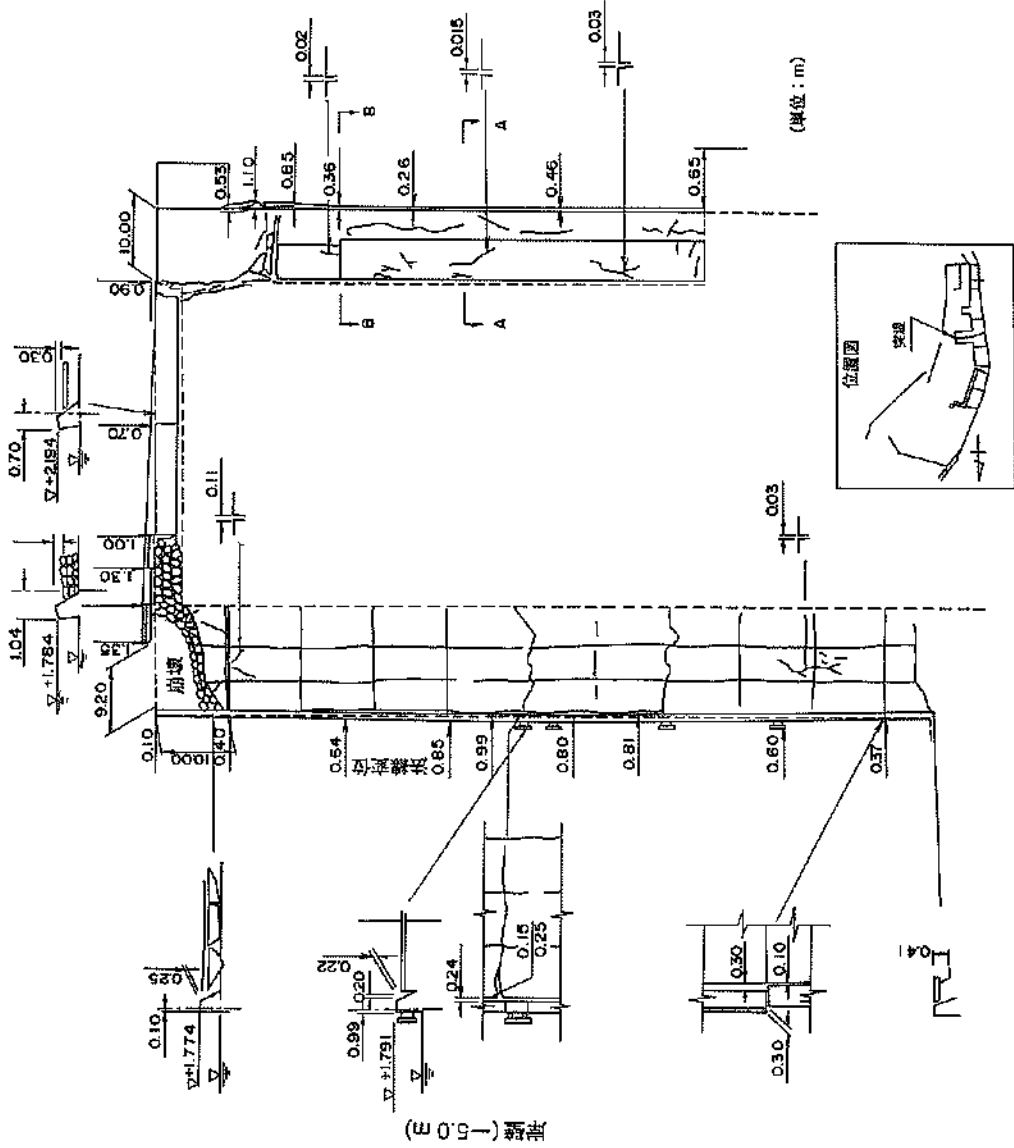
埠頭南物揚場の被災状況平面図・縦断面図
